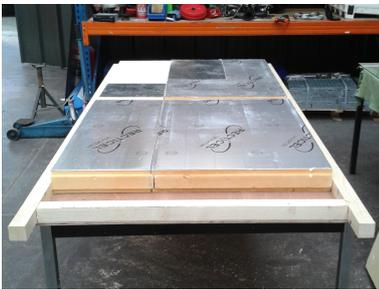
Découpe de la plaque arrière, des poutres pour la structure et de l'isolant + assemblage.
